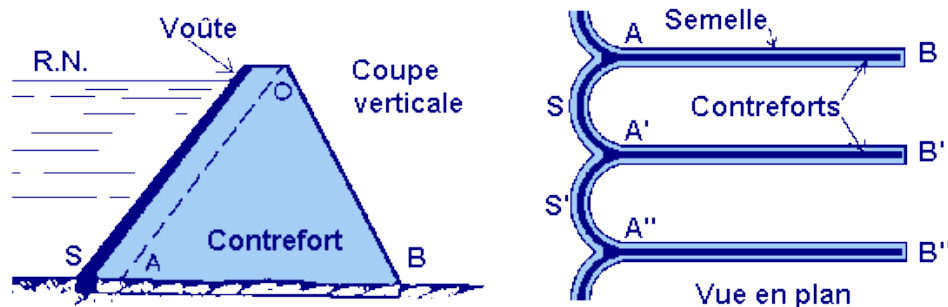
Barrage contrefort (coupe verticale et vue en plan)
